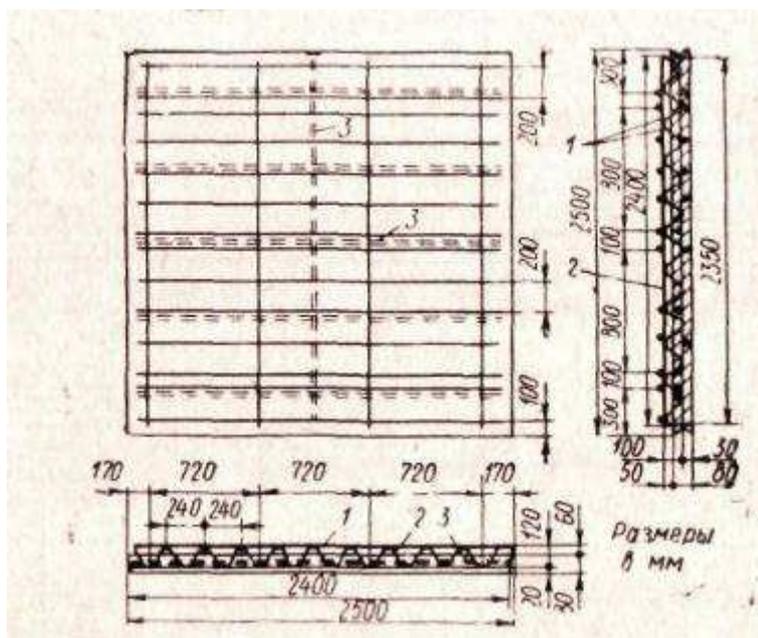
Конструкция гидроизоляционных пропитанных плит-оболочек (к п. 3.63);
